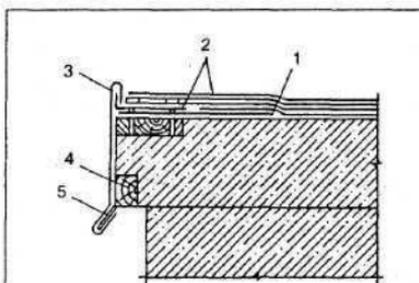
Рулонные кровли. Покрытие фронтона свеса:
